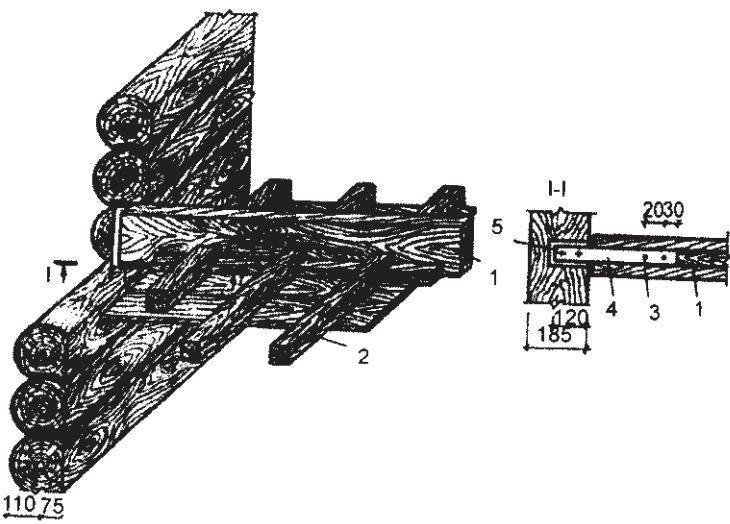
Узел опирания деревянных балок и щитов перекрытия на рубленные бревенчатые наружные стены
